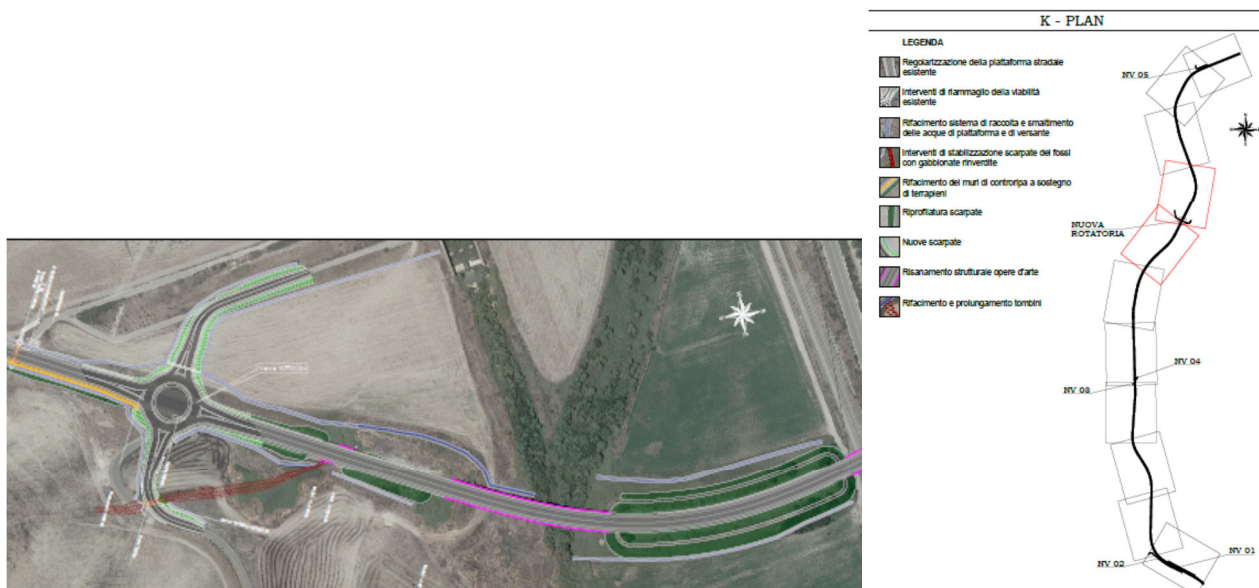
Planimetria di progetto su ortofoto con indicazione della rotatoria (Fonte: Allegati alla Lista di controllo)
